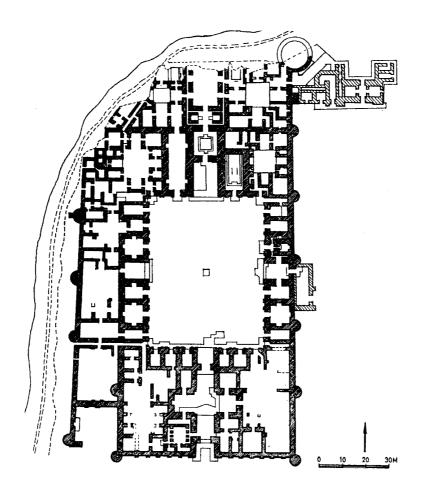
مسقط أفقى لبادستان سيريز باليونان (عن : Cezar) .
